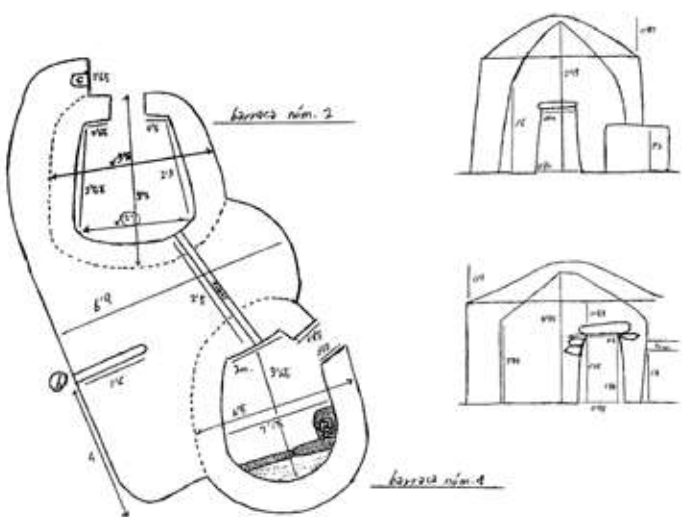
Planta i seccions de les Barraques del Planot (nº 52) tal com estaven l'any 1978.
